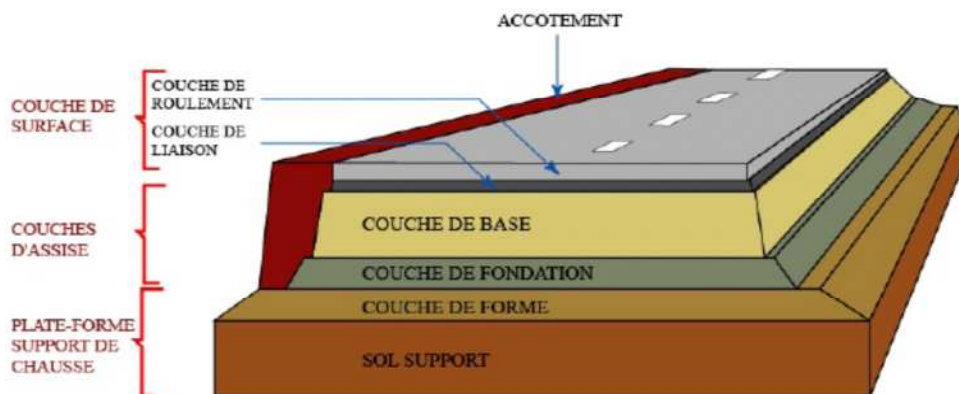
Coupe type d'une structure de chaussée et terminologie des différentes couches
